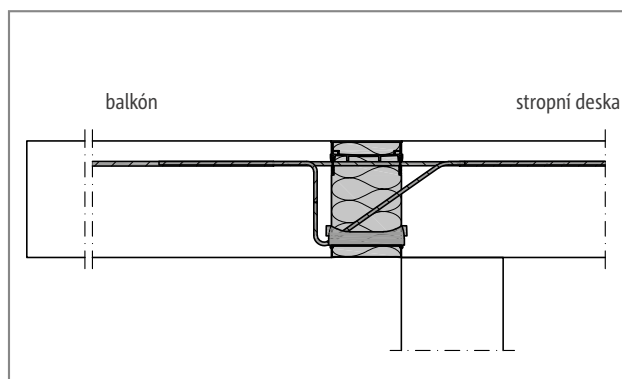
Schöck Isokorb® typ KXT-R0: Uložení v nehořlavých stavebních materiálech, REI30
